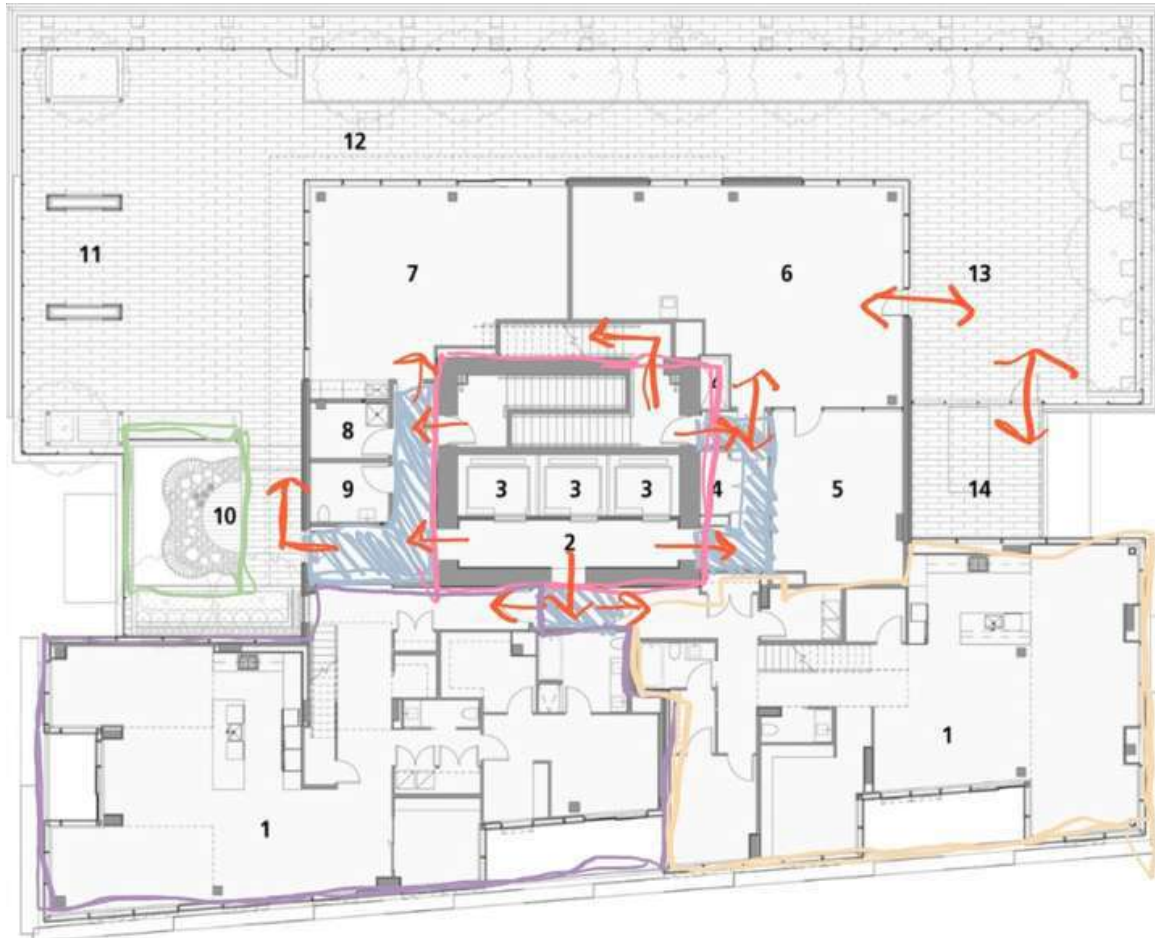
Planta arquitectónica intervenida con análisis. Fuente: Autoría propia
